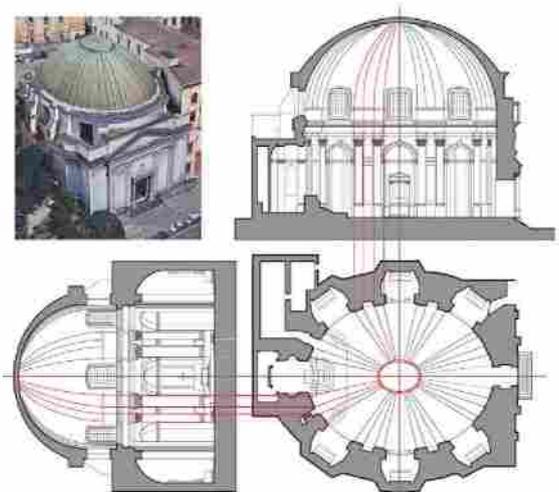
Corrispondenze geometriche tra pianta e sezioni.
